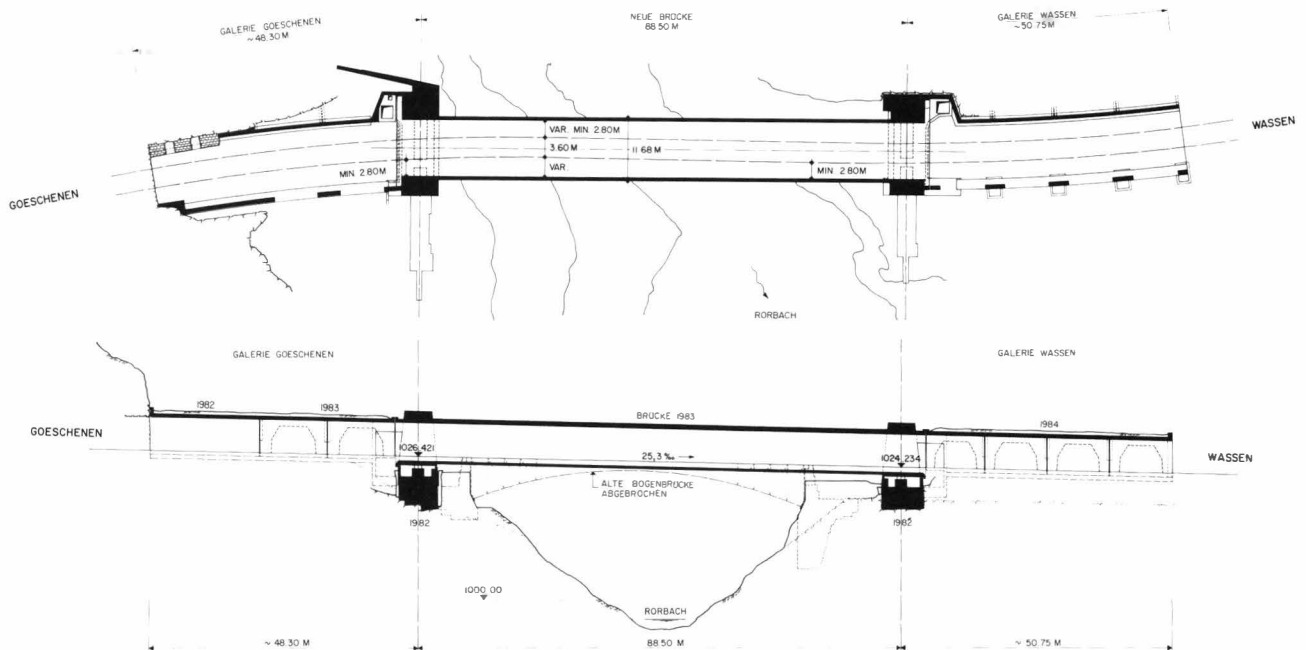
Grundriss und Längsschnitt der fertigen Brücke – Plan et coupe longitudinale du pont terminé – Ground plan and longitudinal section of the completed bridge
